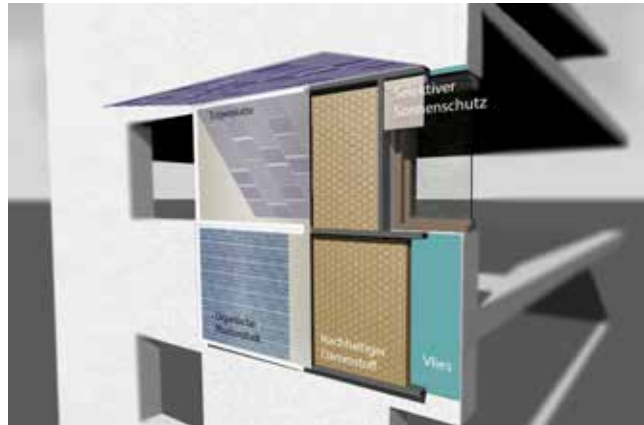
Konzept eines aktiven Fassadenelementes mit horizontalem OPV-Sonnenschutz (Fassade³)
